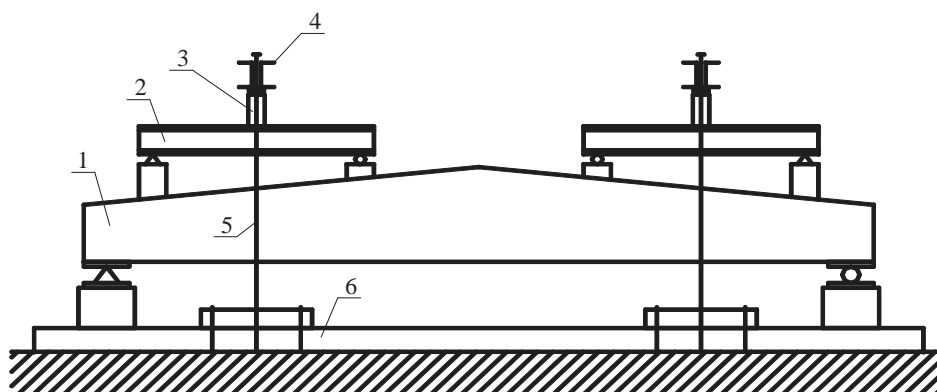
Схема испытания на стационарном стенде: 1 – испытываемая конструкция; 2 – траверсы; 3 – гидравлический домкрат; 4 – поперечные балки; 5 – тяжи; 6 – силовая железобетонная плита
